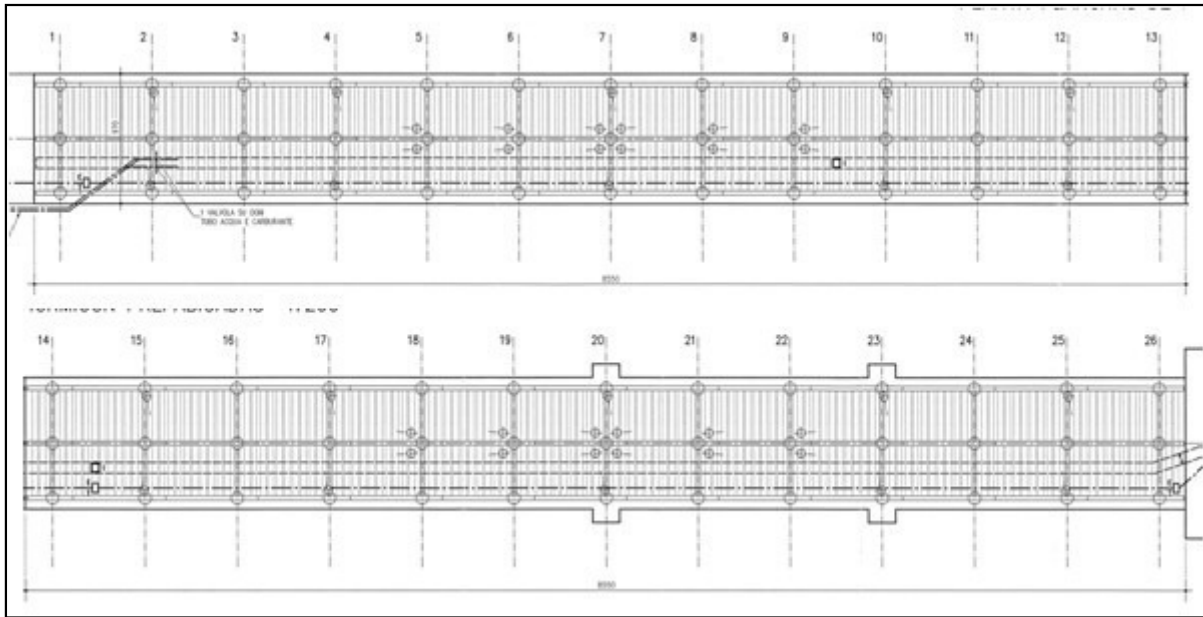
Planta del puente de acceso segunda etapa (Fuente: Planos INCOP)
